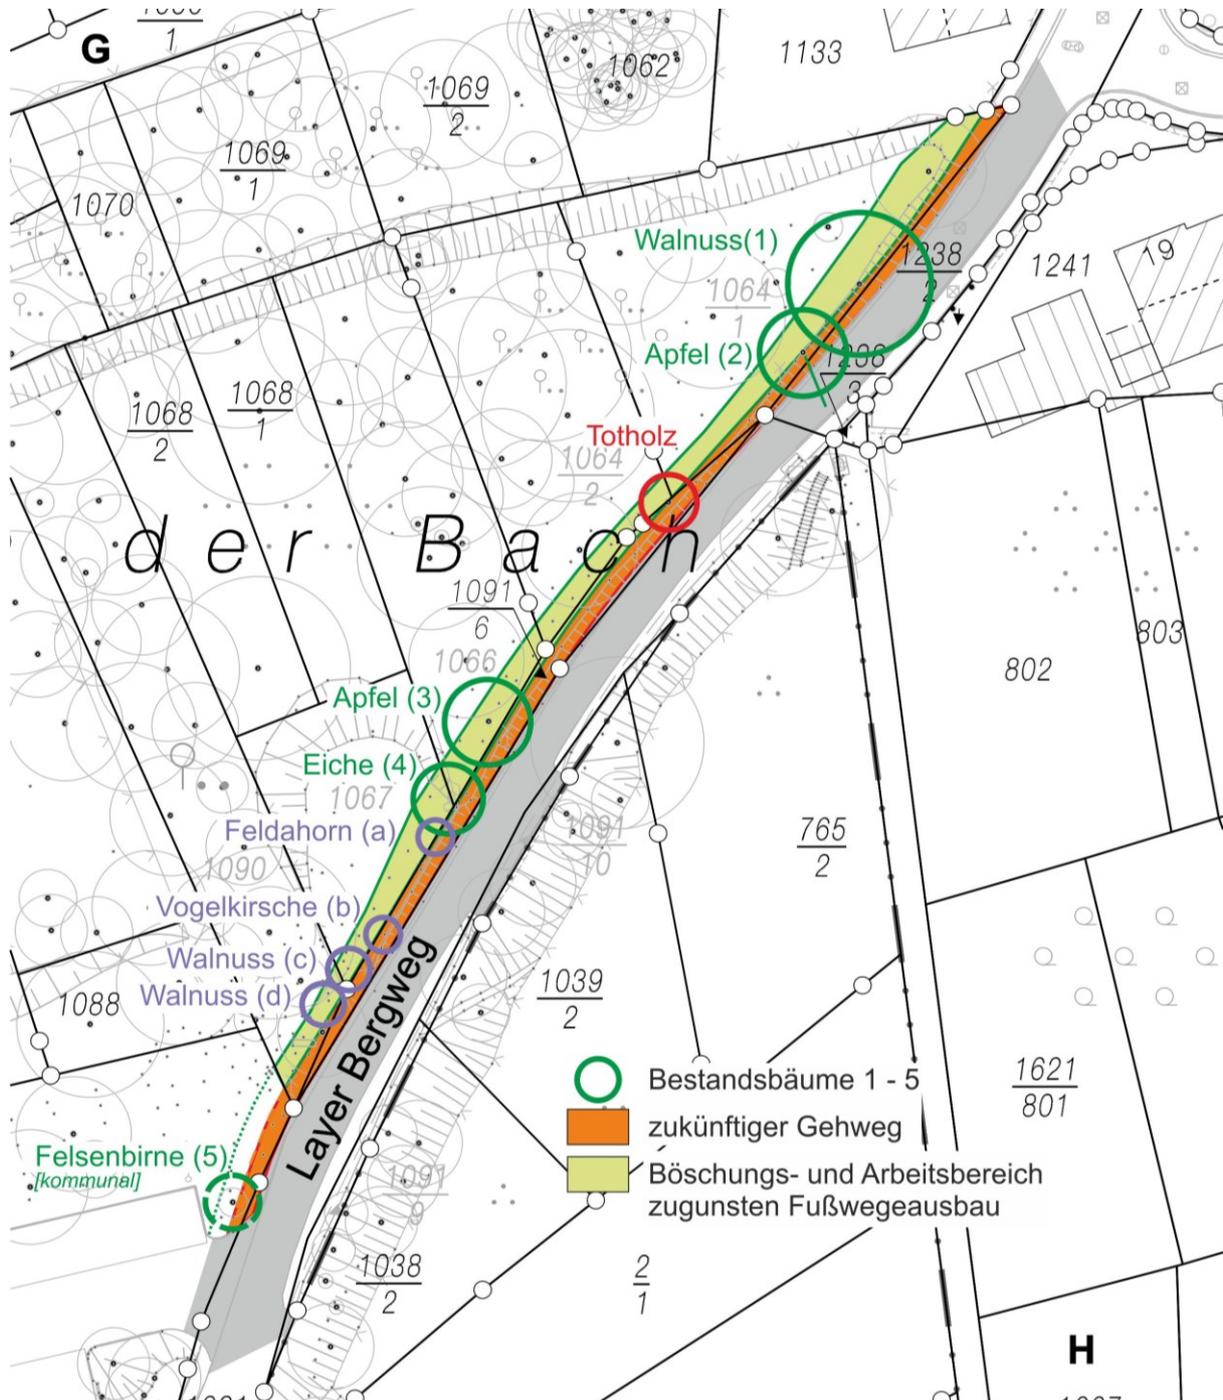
unmaßstäbliche Lagedarstellung der vom Fußwegeausbau betroffenen fünf Bäume
